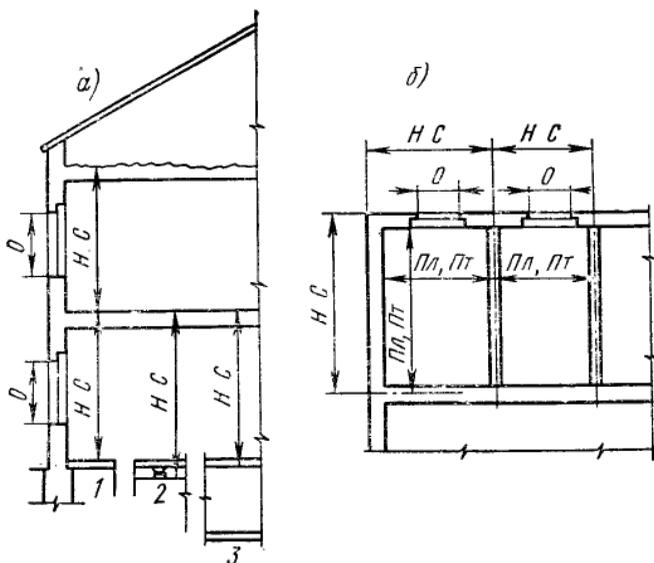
Обмер наружных поверхностей при определении потерь тепла помещениями (НС – наружных стен, Пл – пола, Пт – потолка, О – окон): а – разрез по зданию, б – план здания; измерение высоты стен 1-го этажа при конструкции пола: 1 – по грунту, 2 – по лагам, 3 – над неотапливаемым помещением
